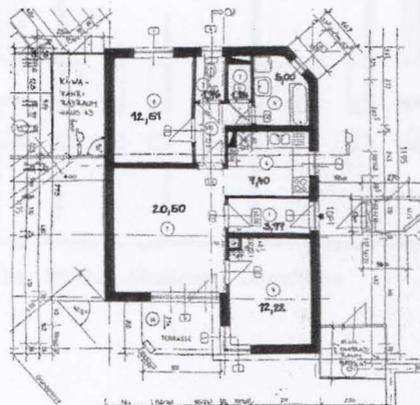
Tannhof IV Grundriss 68 m²
